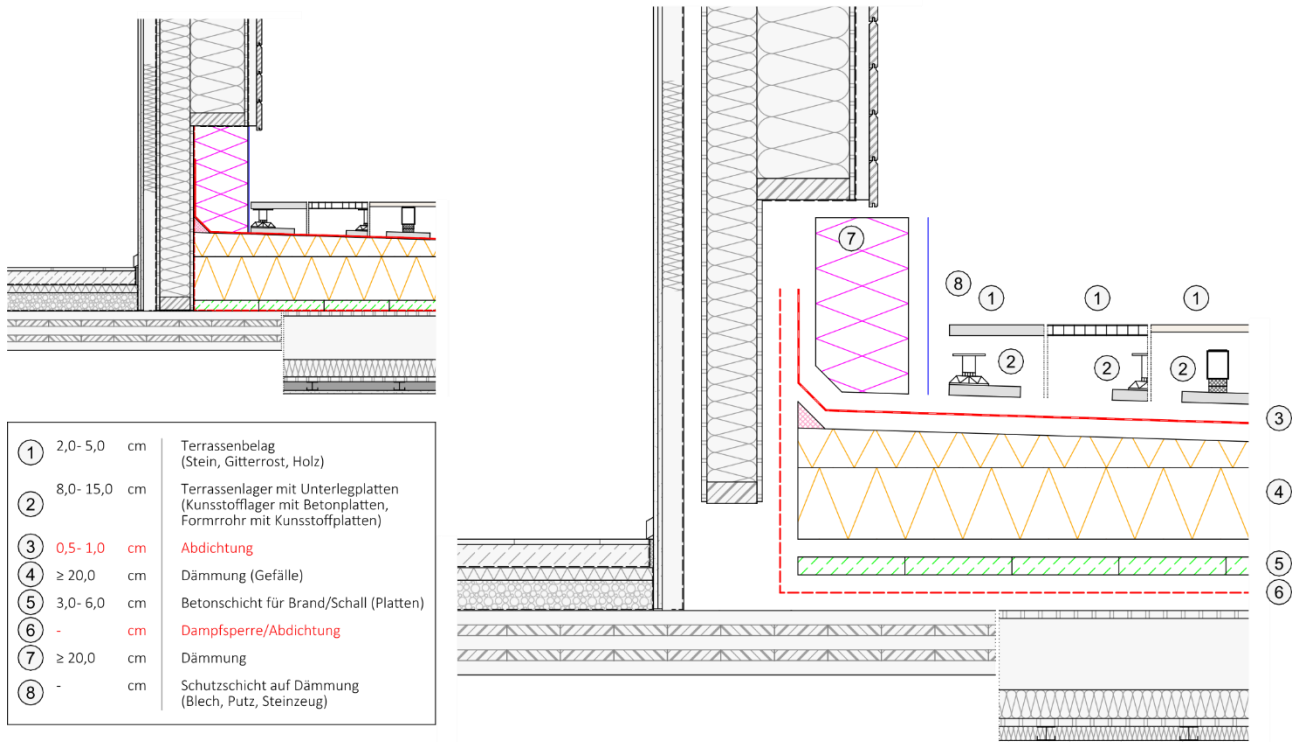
Detailausbildung – Holzrahmenbau ausgeklinkt auf Holzuntergrund
